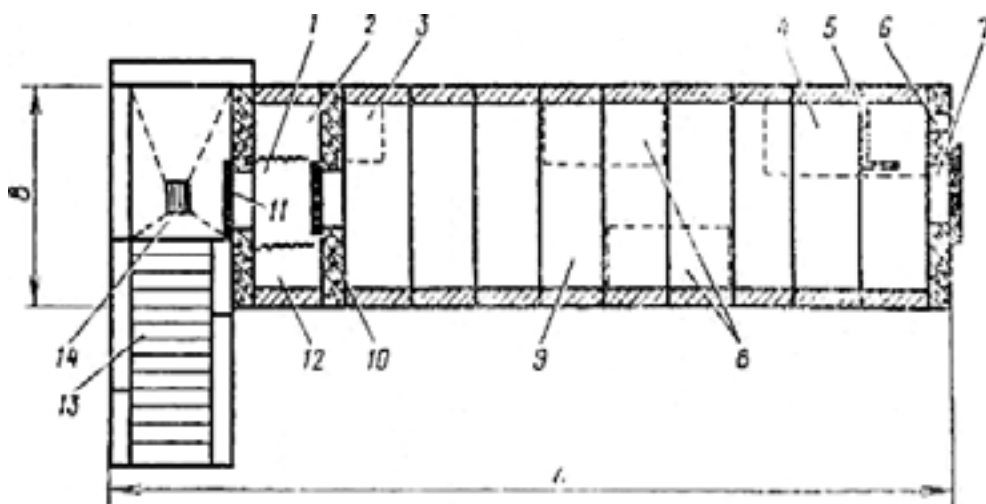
Пример планировки БВУ на 50 чел.: 1 – тамбур; 2 – санузел; 3 – санпост; 4 – место для установки вентиляционного оборудования; 5 – защитный экран; 6 – воздухозабор; 7 – аварийный выход; 8 – место для хранения продовольствия; 9 – помещение для укрываемых; 10 – герметическая дверь; 11 – защитно-герметическая дверь; 12 – место для хранения загрязненной верхней одежды; 13 – вход; 14 – водосборный приямок
